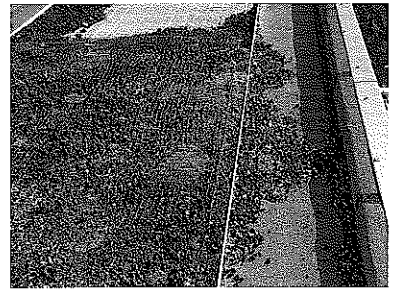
緑化植物の定着はまばらで、軽量土壌の飛散が著しい
